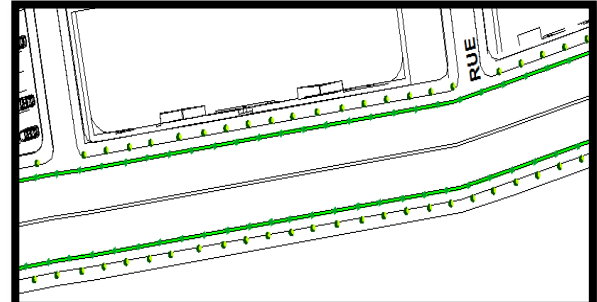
Vue en plan sur la rue Med Belouizded après l'intervention.
